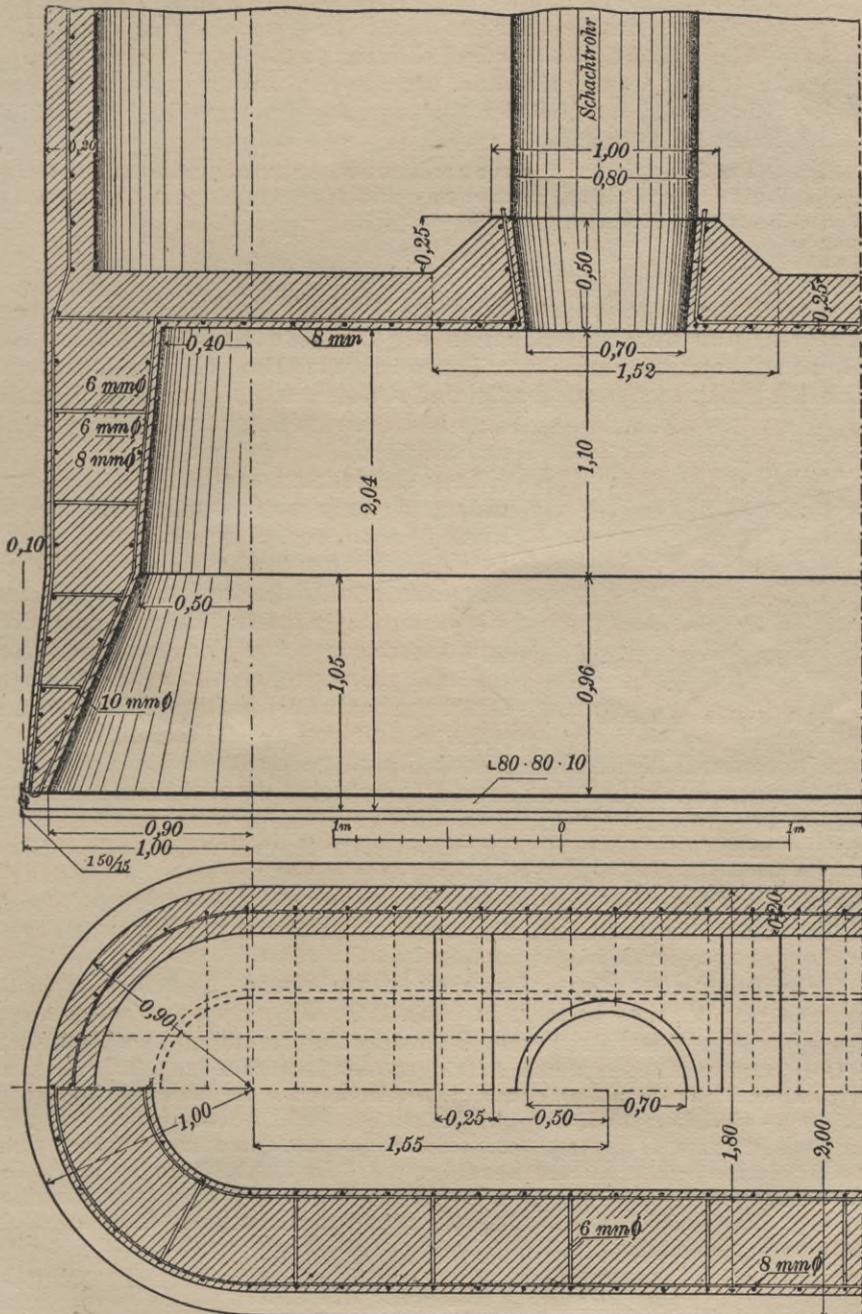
Senkkasten aus Eisenbeton („Handbuch für Eisenbetonbau“).
